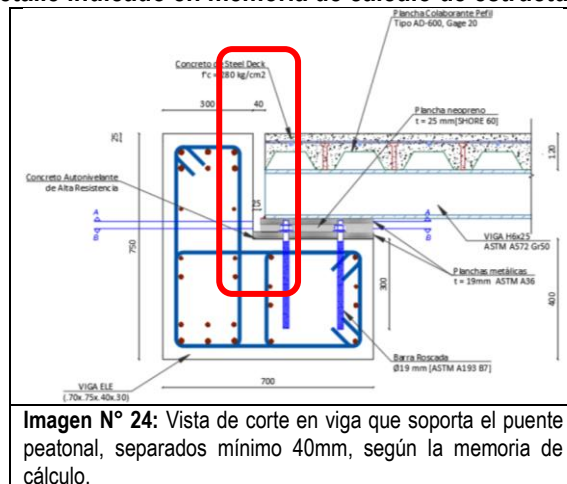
Vista de corte en viga que soporta el puente peatonal, separados mínimo 40mm, según la memoria de cálculo.
